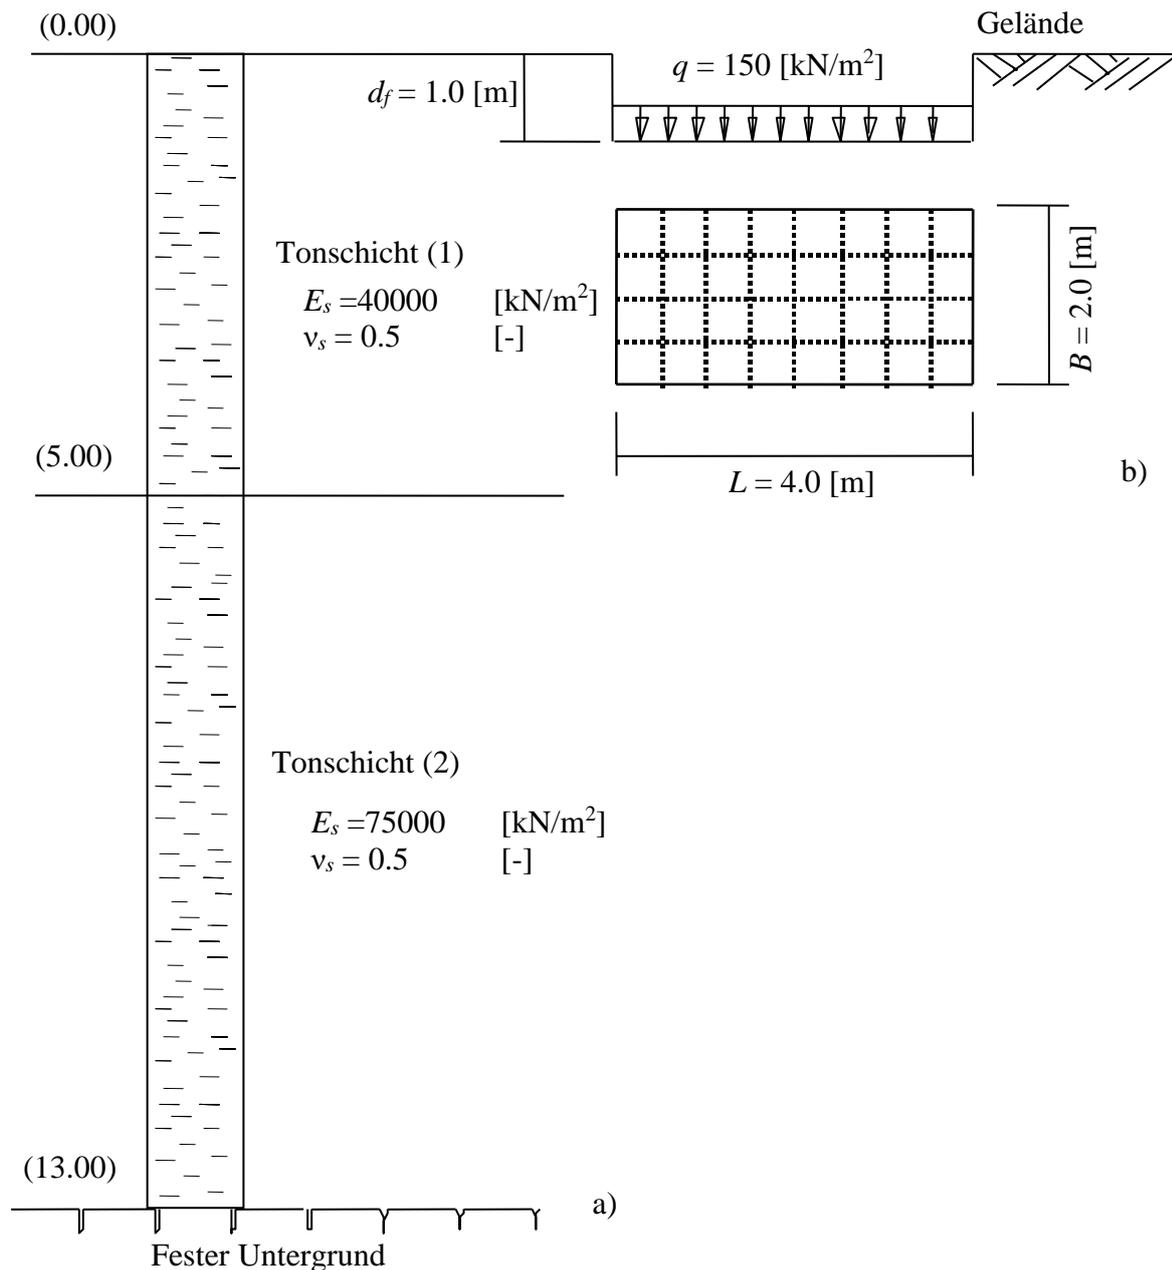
a) Querschnitt durch den Baugrund unter dem Fundament
